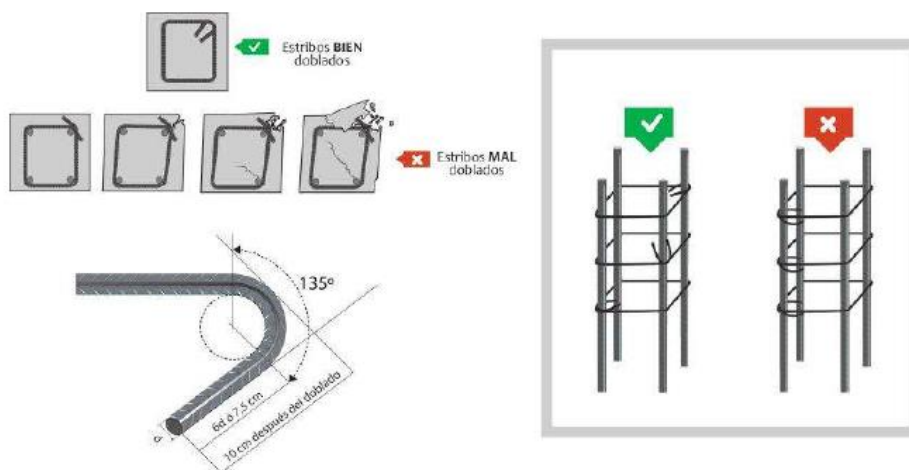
Doblez de Gancho y Colocación Alternada de estribos
